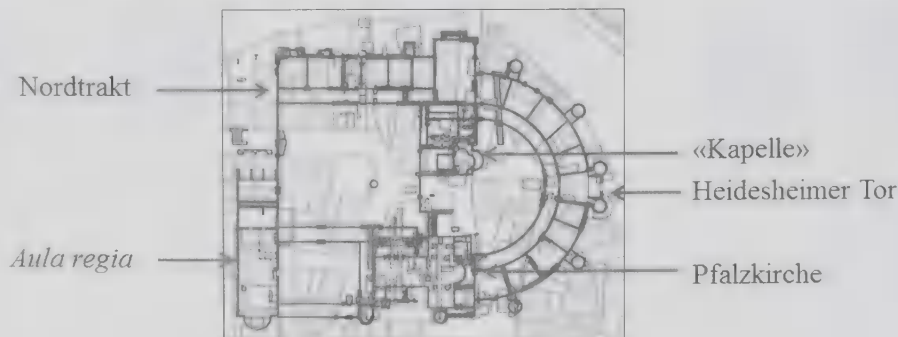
Grundriss der Pfalz (aus Grewe 2014a, 64).
